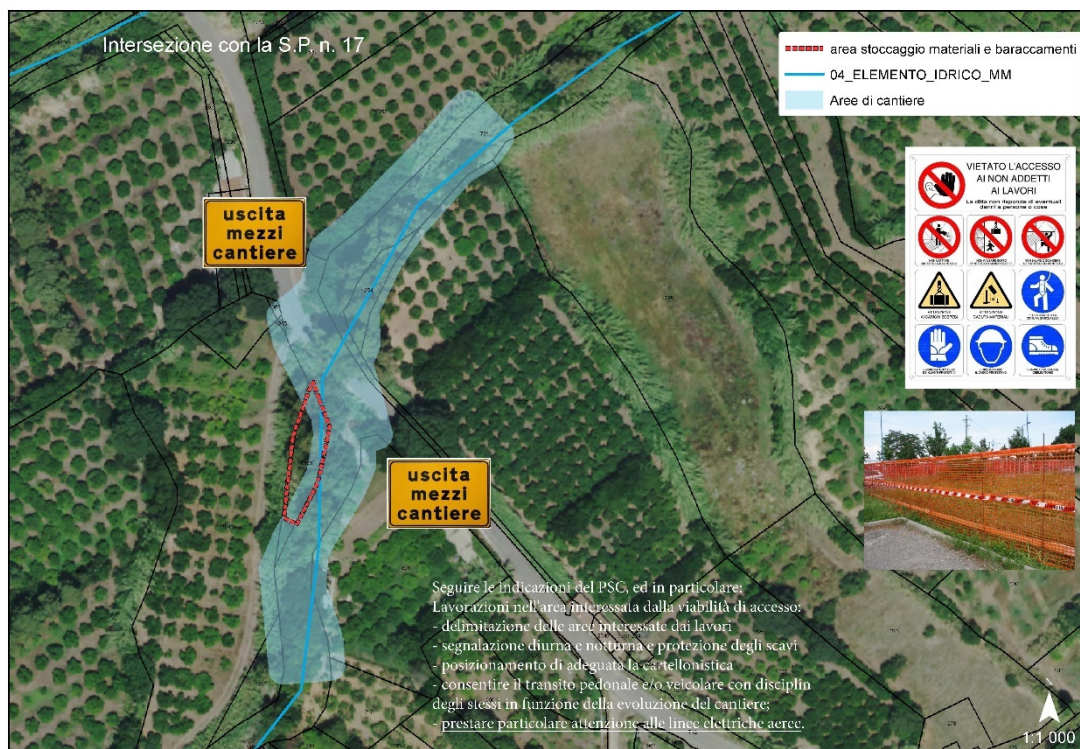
Stralcio Layout di cantiere intersezione ex S.P. n. 17
